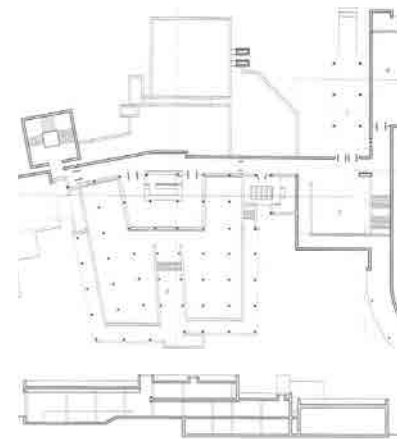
y Fig. 61 Pabellón de comedor y cocina del Centro de Orense. Planta superior (arriba) y sección transversal (abajo). En la sección se observa la bandeja sobre la que se sitúa la cafetería, el plano de las mesas del comedor y el del deambulatorio perimetral, así como el lucernario.
